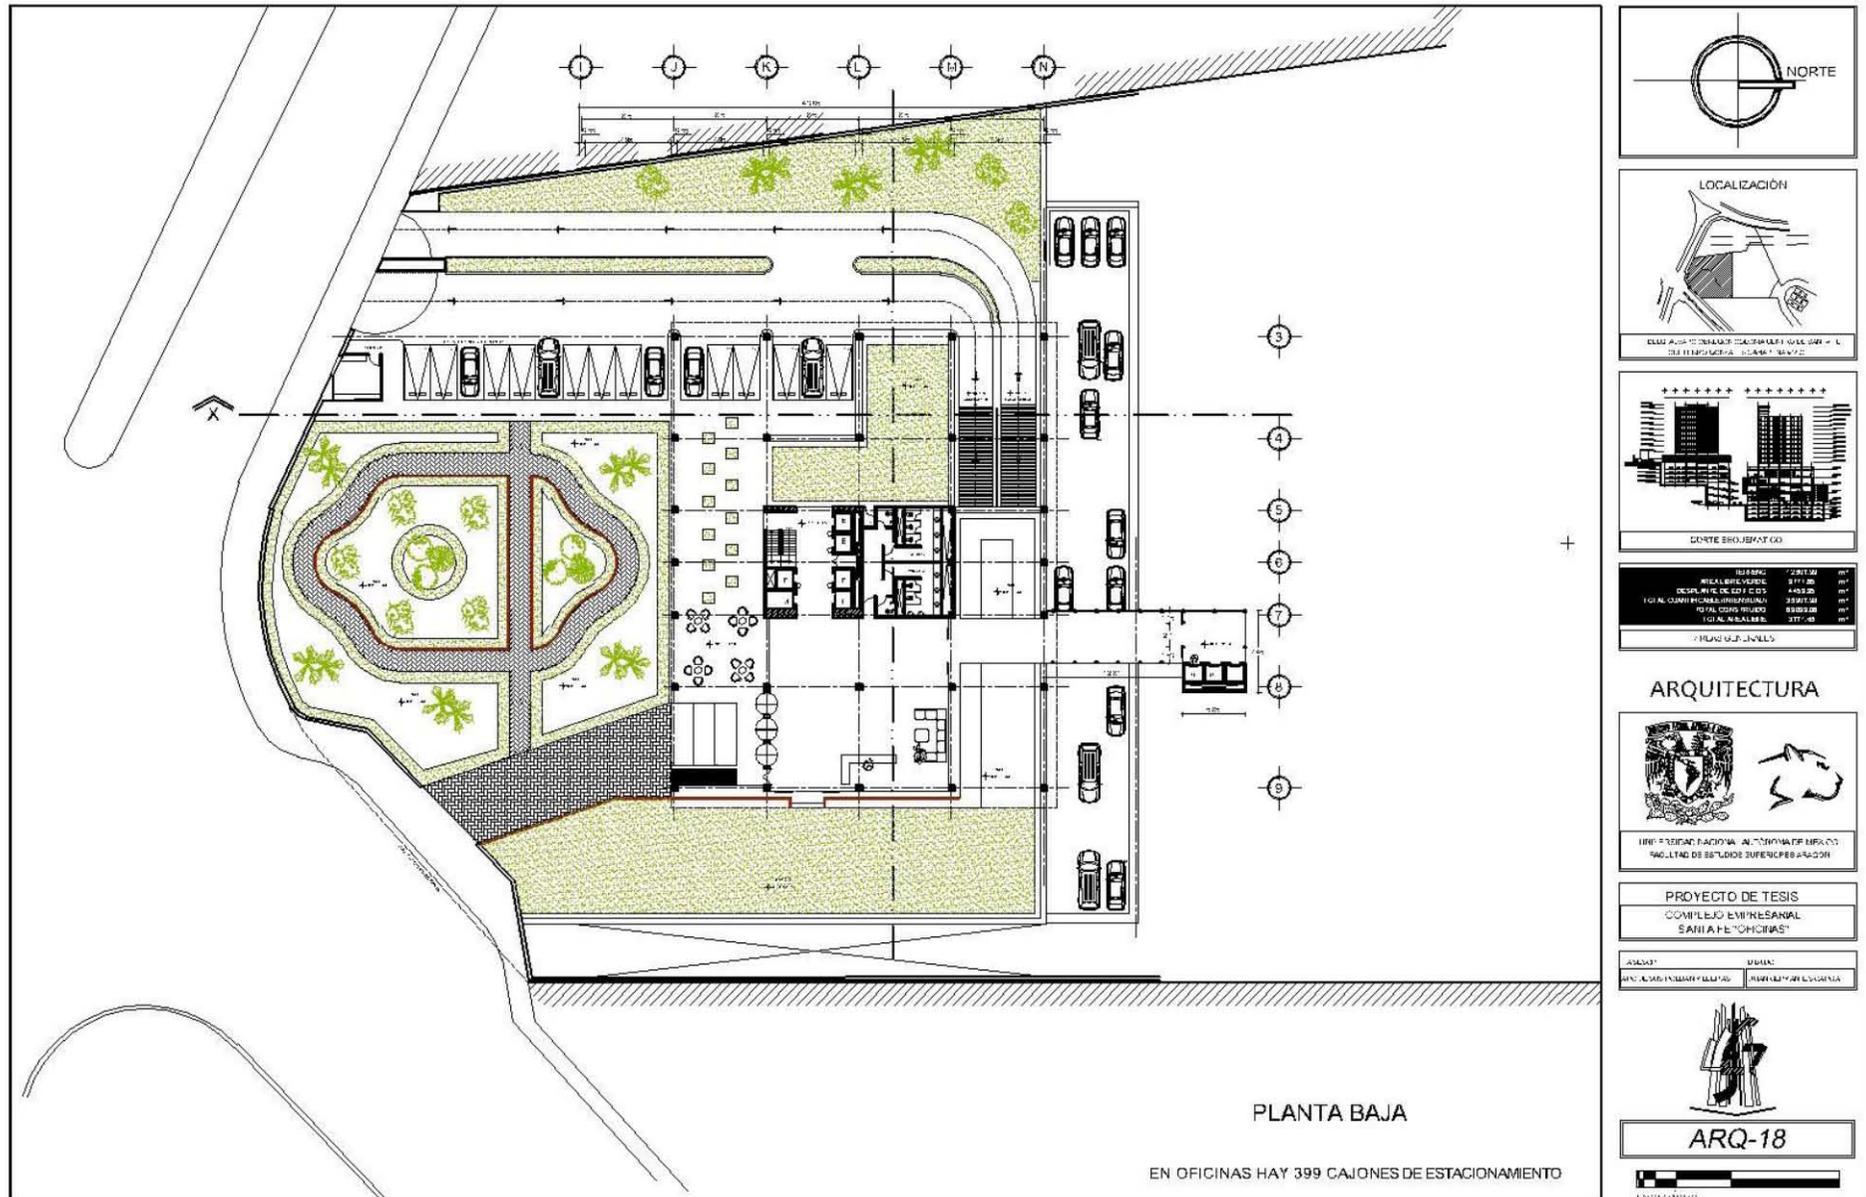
Plano ARQ-18; Planta Baja Oficinas. Edición propia.
